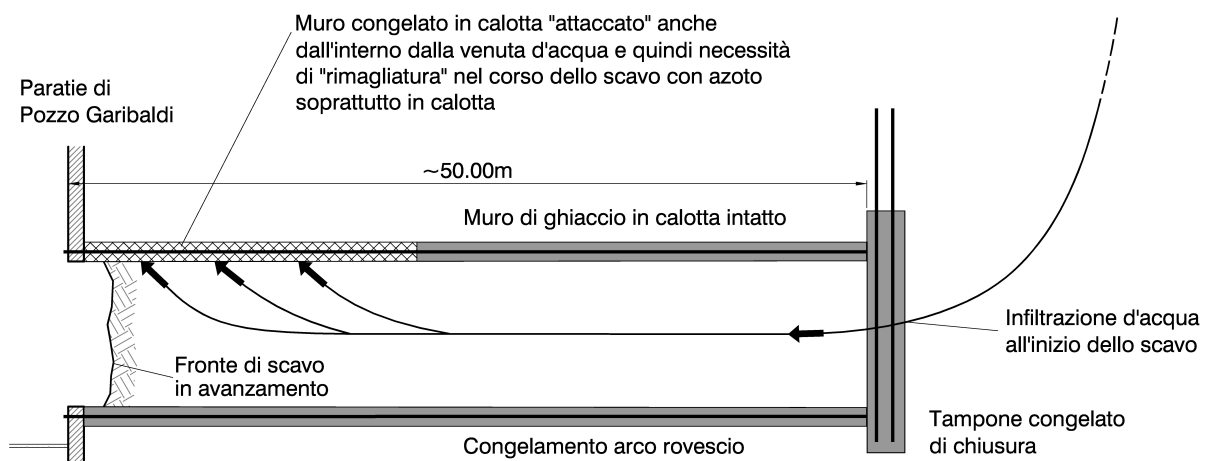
Fenomeno anomalo avvenuto all'inizio dello scavo che ha costretto ad utilizzare azoto liquido in alcune sonde di calotta e piedritti (avendo qui arrestato la salamoia di mantenimento)
